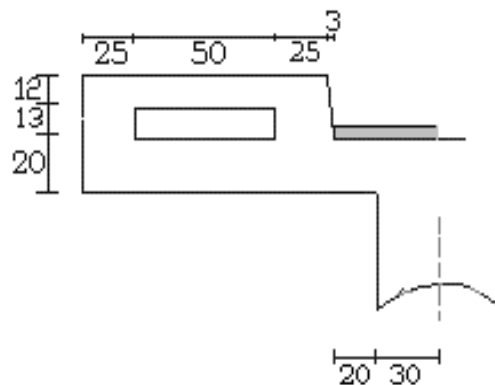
Ancho de pavimento en voladizo. Dimensiones en (cm).
